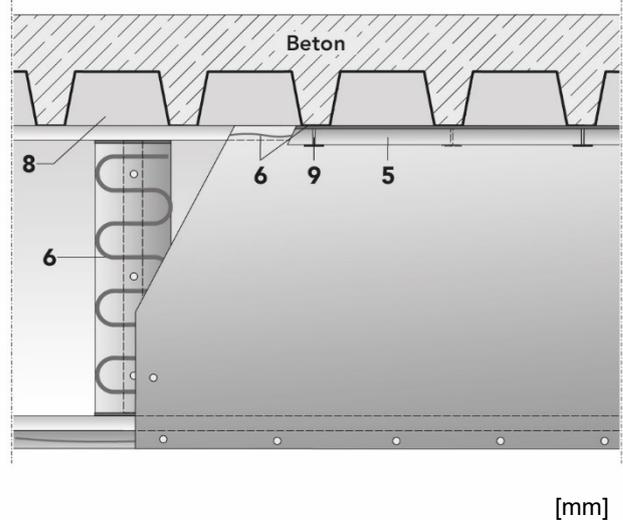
Anschluss an Stahltrapezblech-Verbunddecke – Variante 3
